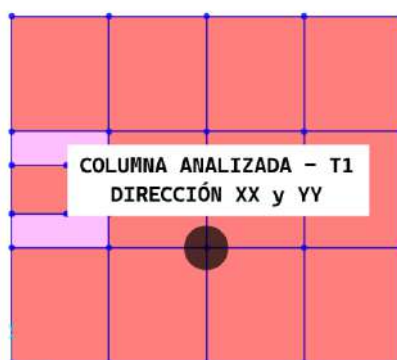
Bloque B y D: Ubicación de las columnas para el cálculo de la rotación,
